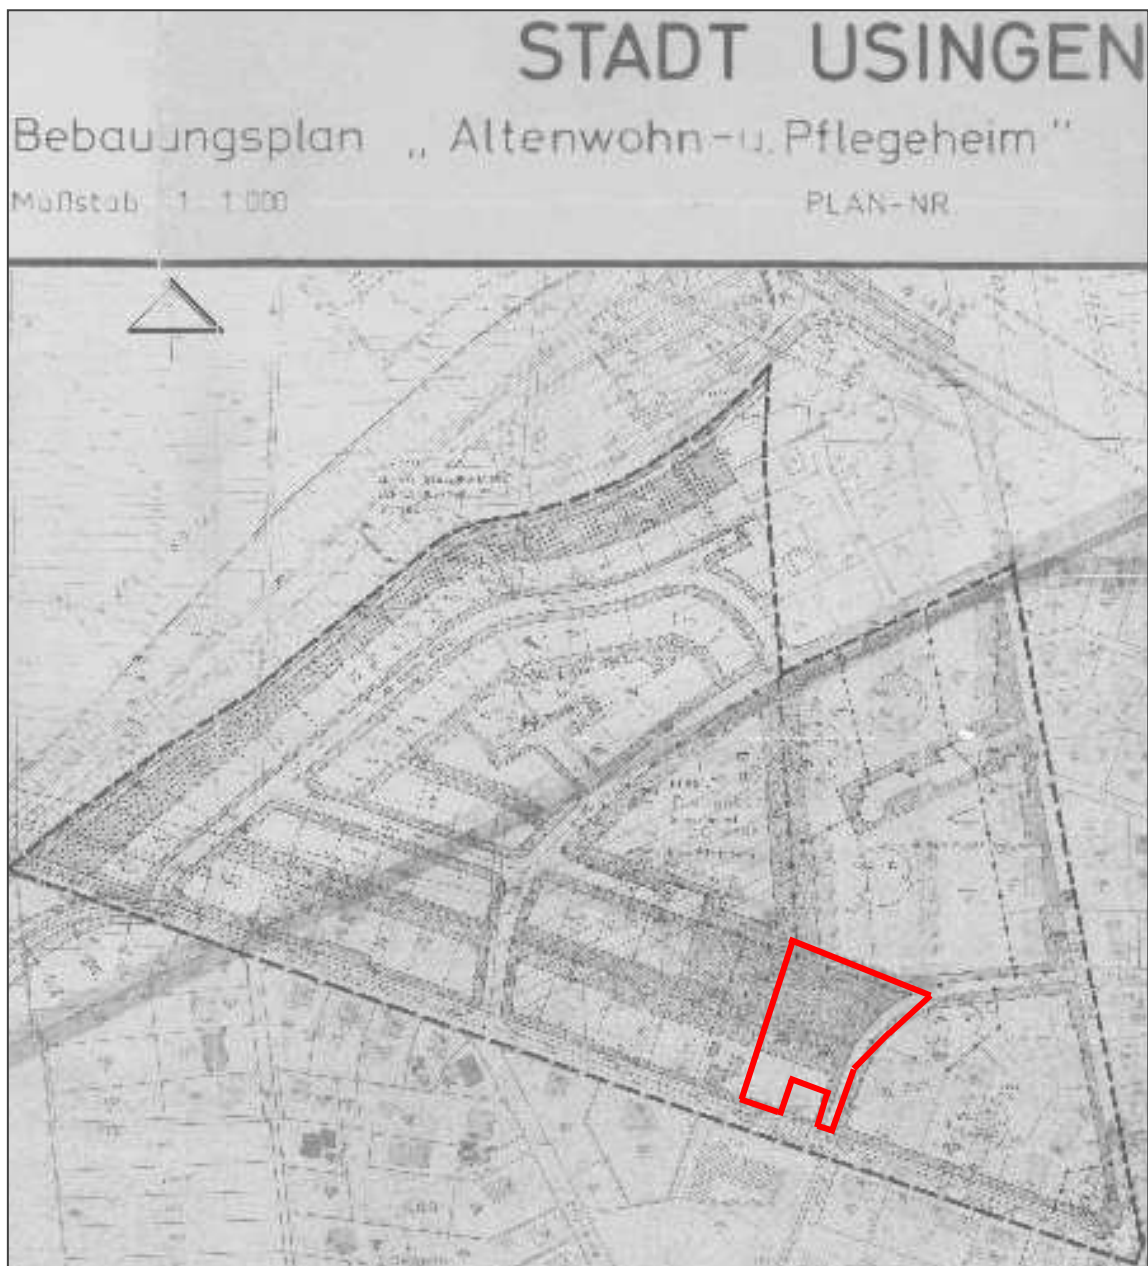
Lage des Plangeltungsbereichs der Änderung innerhalb des geltenden Bebauungsplans o. M.
